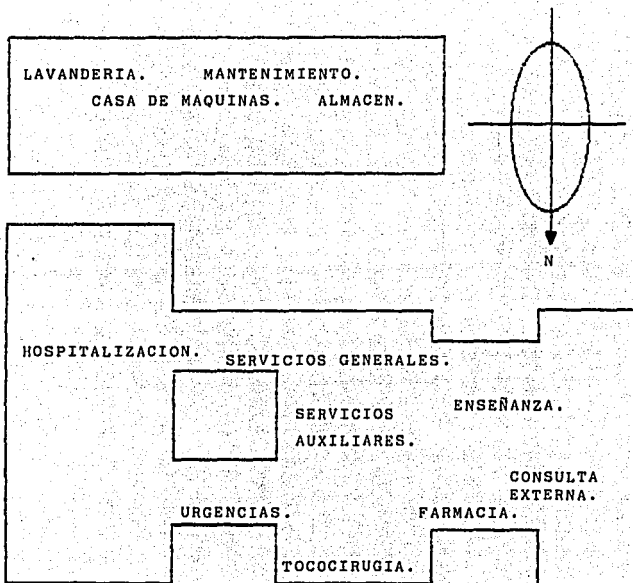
CROQUIS DEL HOSPITAL EN PROYECTO.
